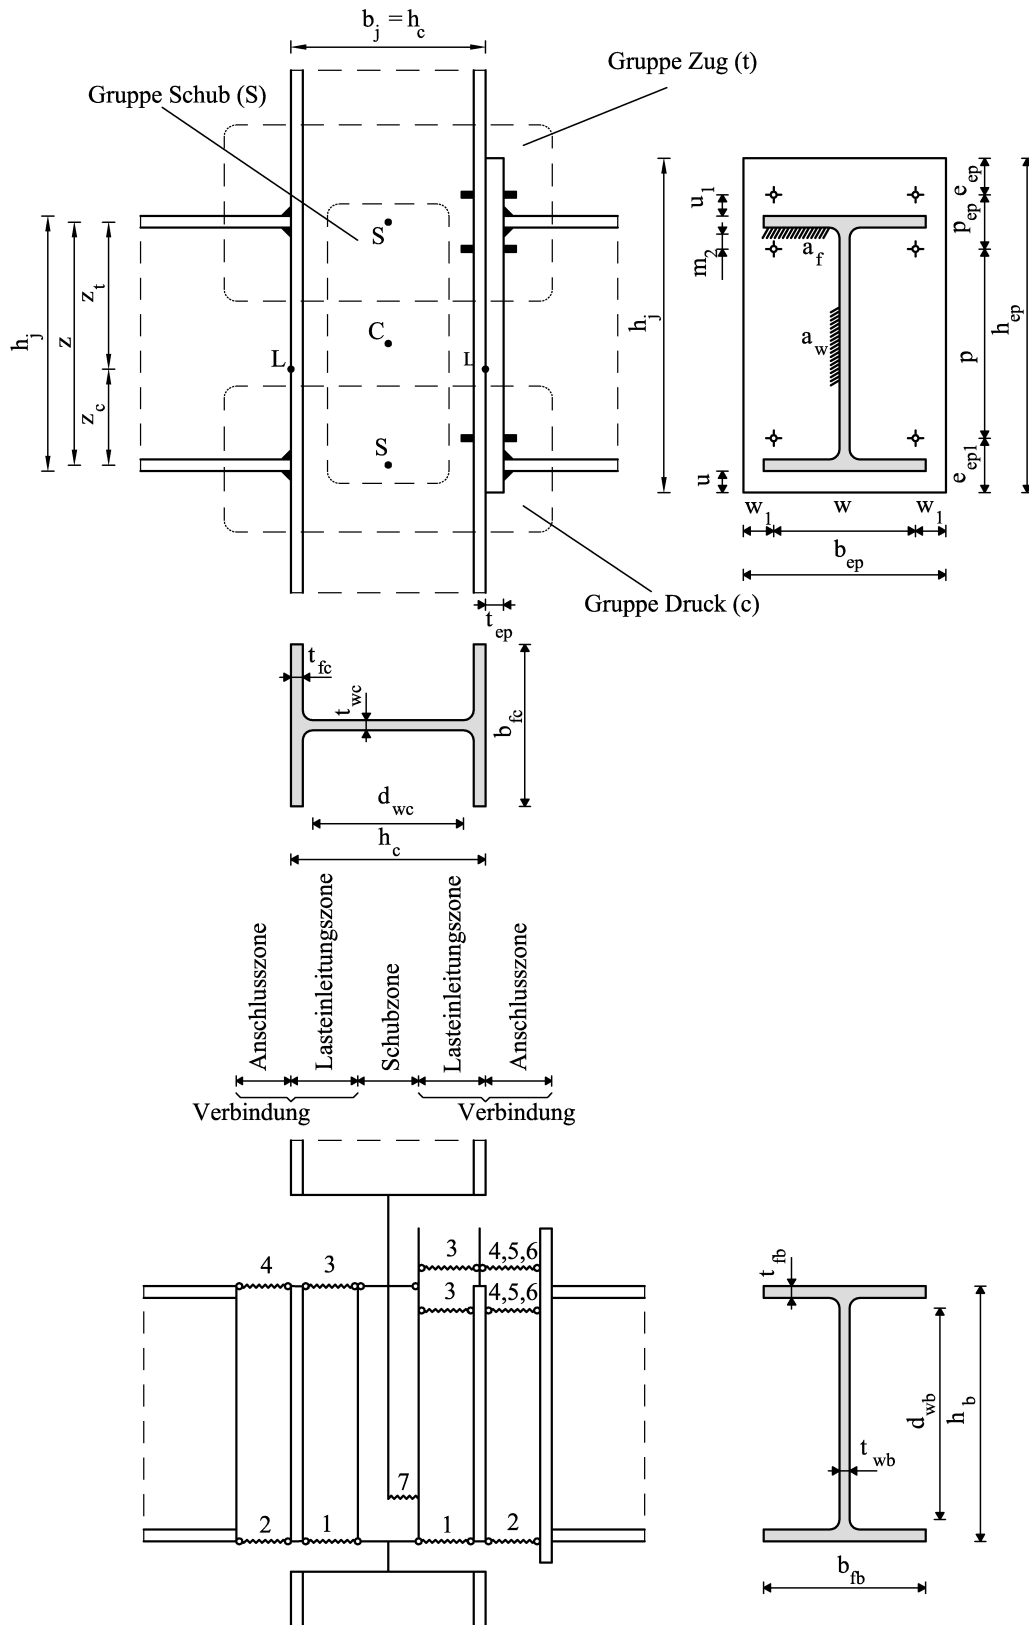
Geschweißter (links) und geschraubter (rechts) Stahlknoten
